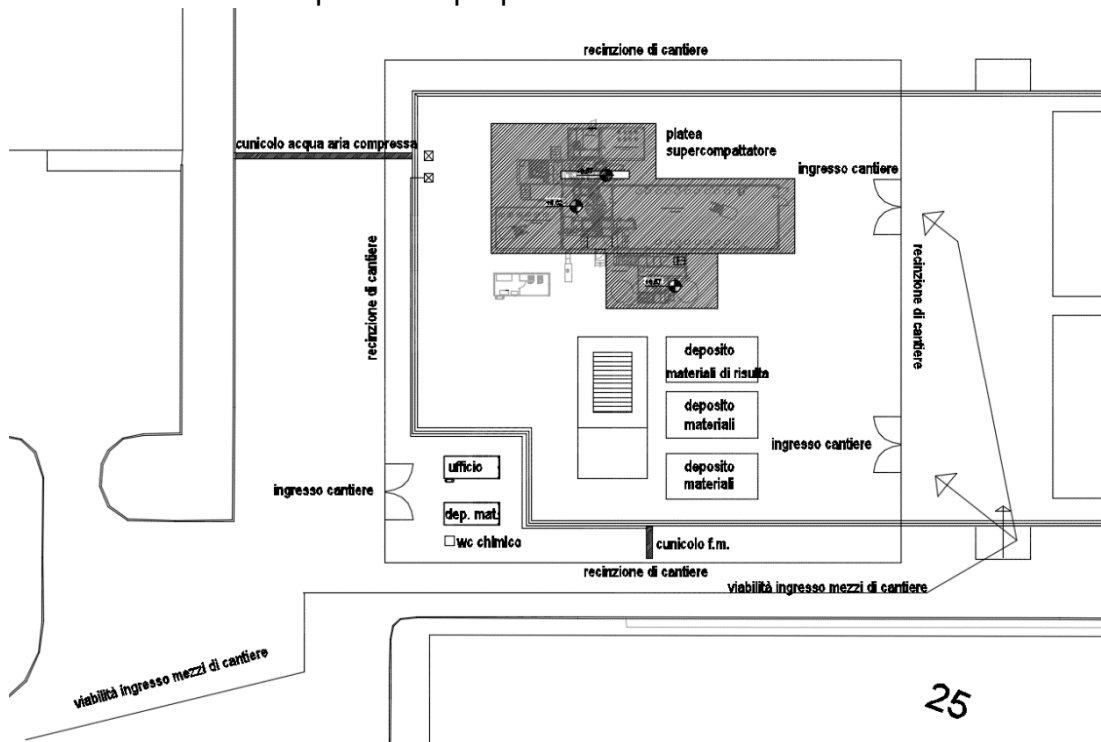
Lay out di cantiere per le opere di predisposizione dell’area destinata all’installazione del sistema trasportabile
